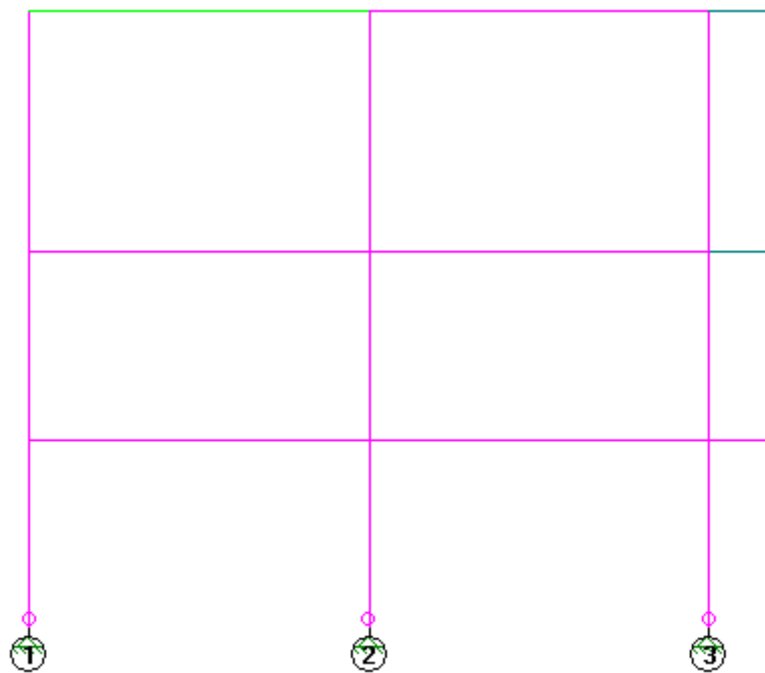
Modelo Estrutural – Elevação do Eixo C
